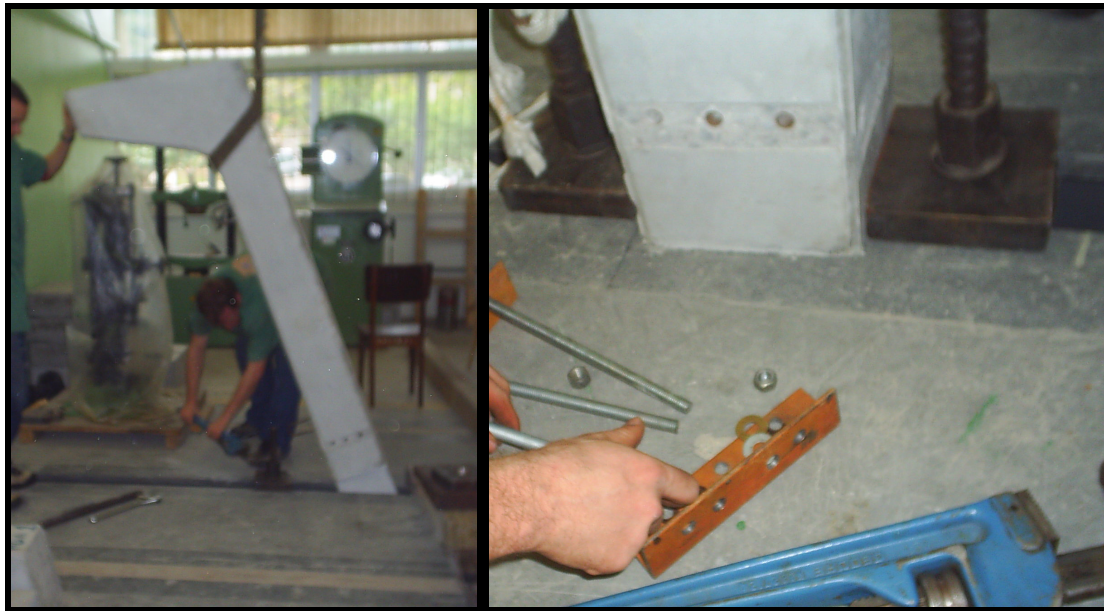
Encaixe do pilar na laje de reação e travamento inicial
